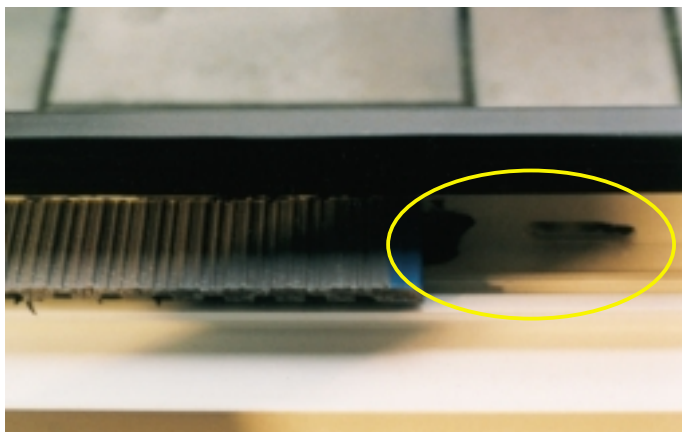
Unten im Glasfalz sind Öffnungen für den Dampfdruckausgleich zu sehen. Entsprechende Öffnungen fehlen im oberen Falzteil jedoch gänzlich
